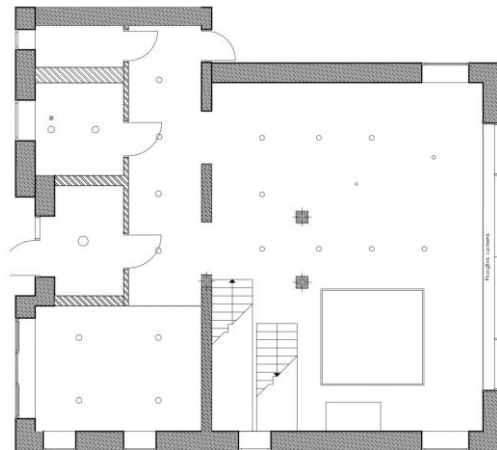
План освітлювальних приладів 1 поверху котеджу
